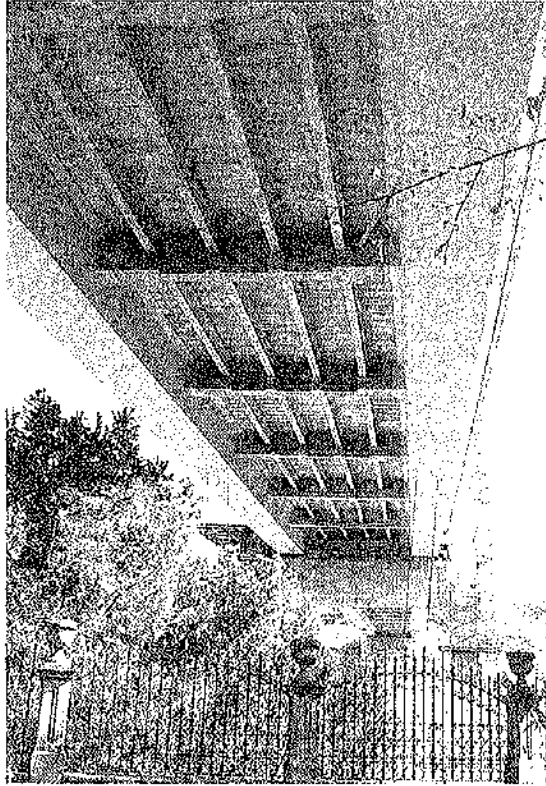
Puente de Alcoy. Tecnología de puente atirantado con el tablero ejecutado totalmente con piezas prefabricadas.
